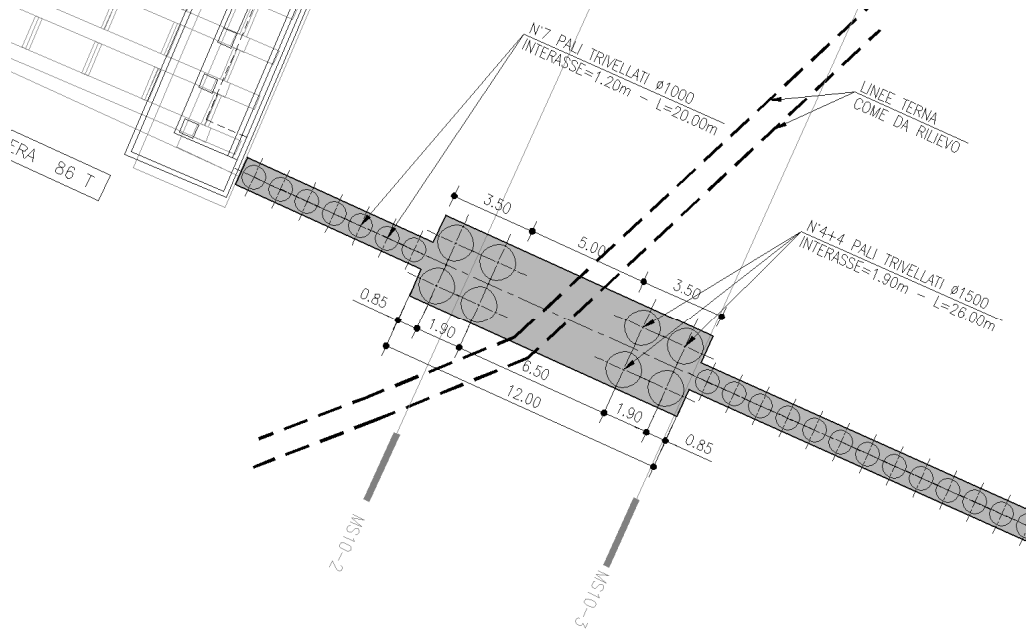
Opera di scavalco linea TERNA esistente - Pianta
